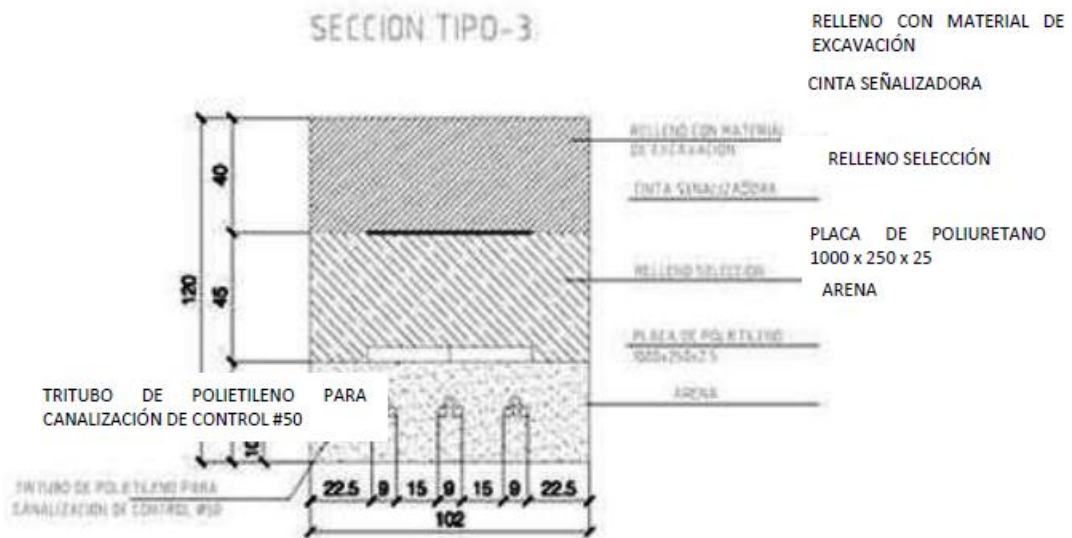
Tendido de cableado de más de dos circuitos (Sección Tipo III).
